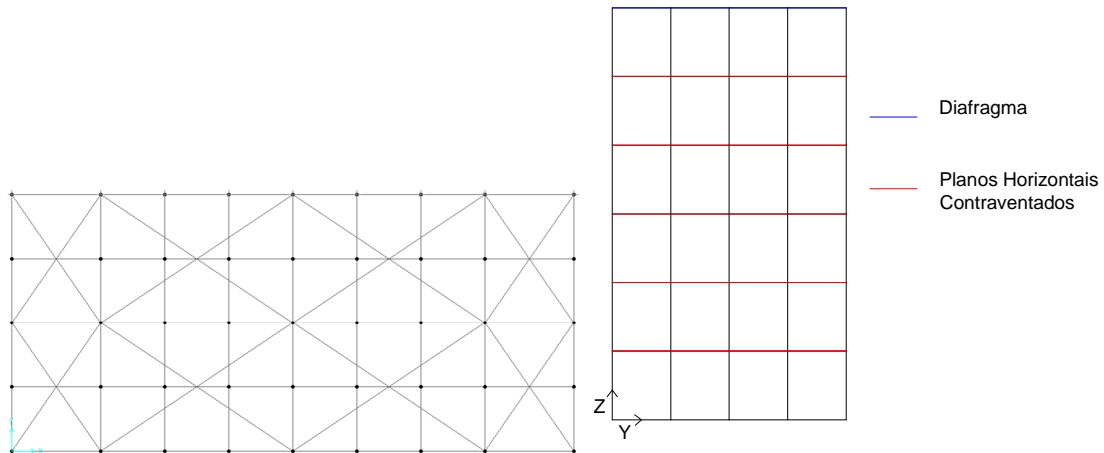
Configuração dos Planos de Contraventamento Horizontal Com Elementos de Contraventamento Grandes
